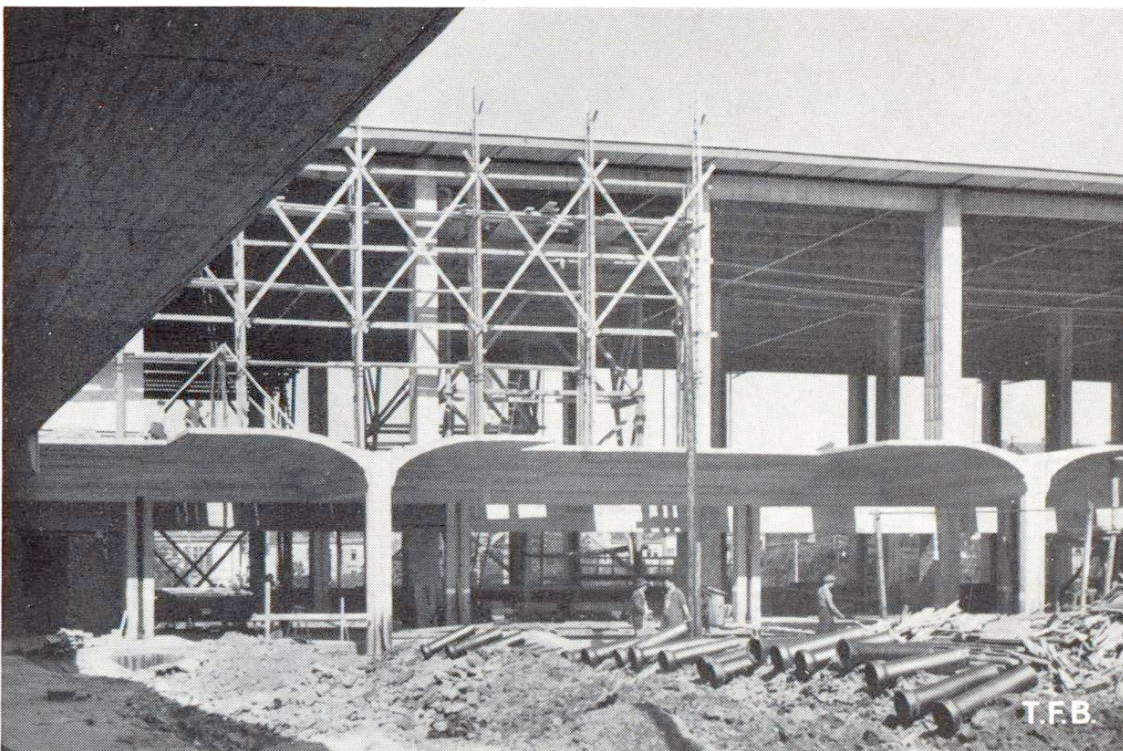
Halle principale. A gauche, échafaudages pour la pose des parois vitrées. Avant-toits et partie de la couverture des quais par des dalles minces en béton armé (Vue en coupe)
